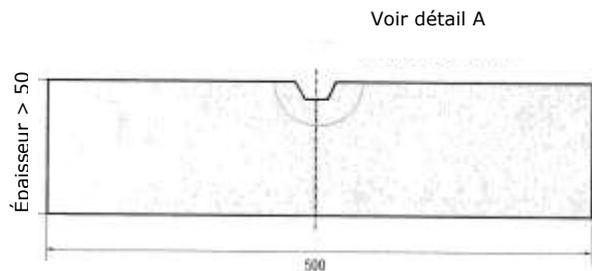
Sto-Panneaux pour Bossage Type II (dimensions en mm)
